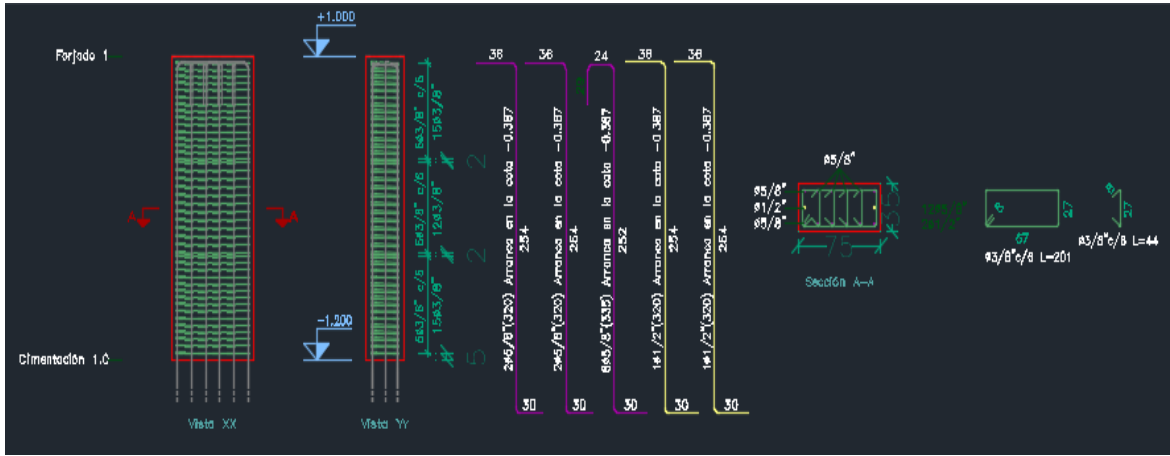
Dimensiones zapatas y pedestales. Fuente: planos estructurales
